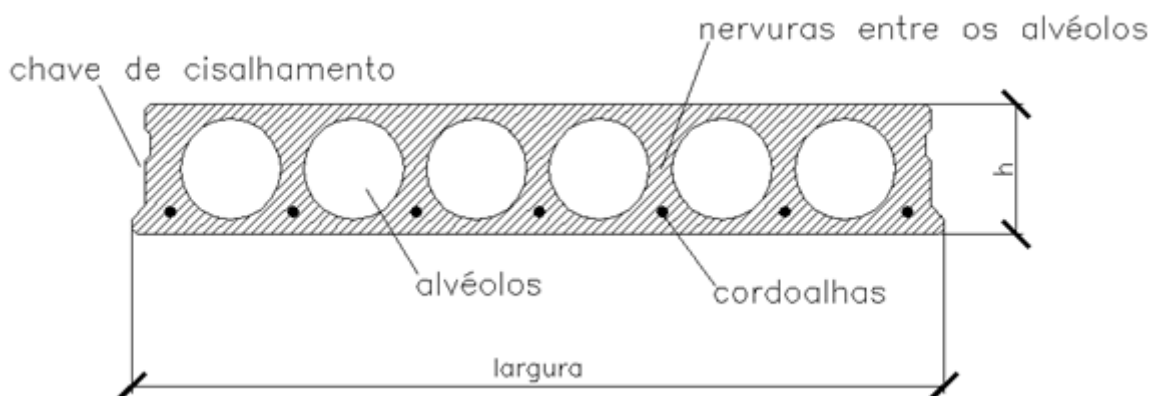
SEÇÃO TRANSVERSAL TÍPICA DAS LAJES ALVEOLARES.
